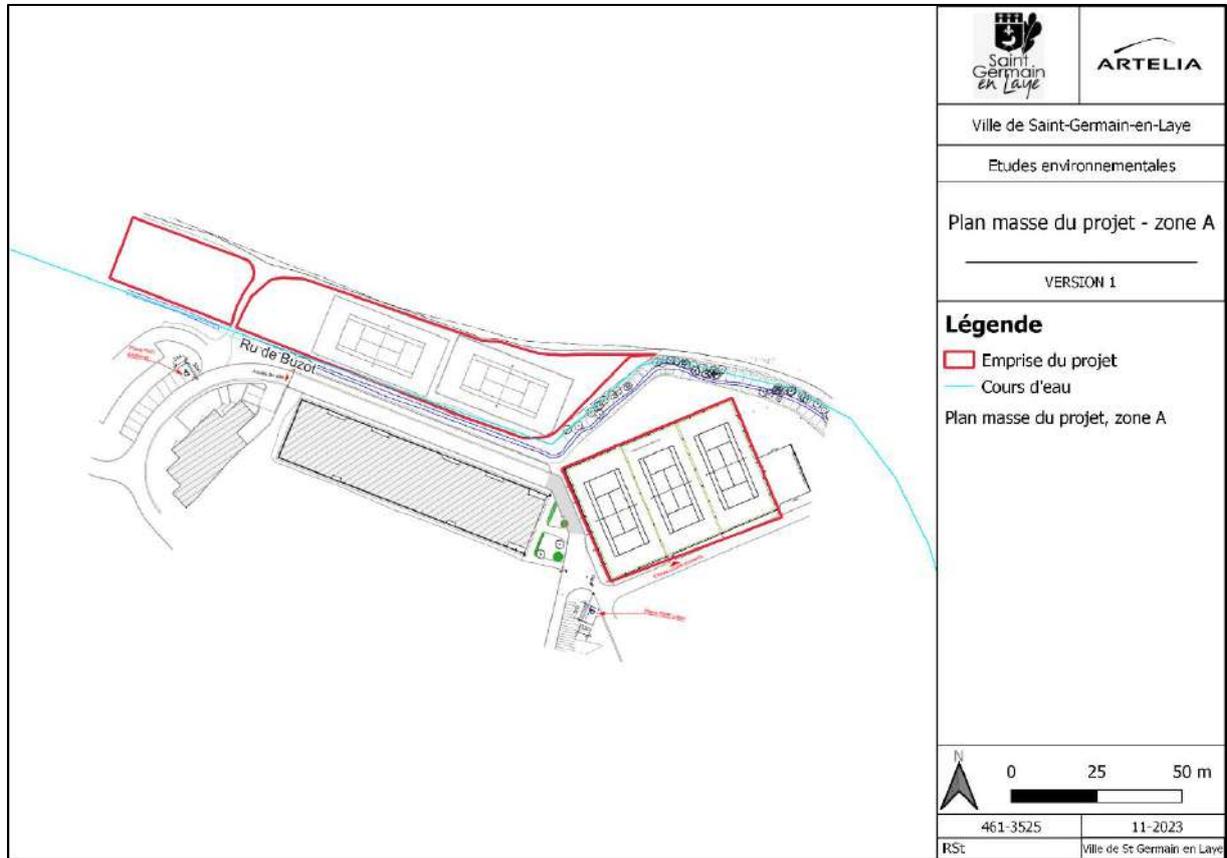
Plan masse du projet, zone A, SAS Architecture 3J
